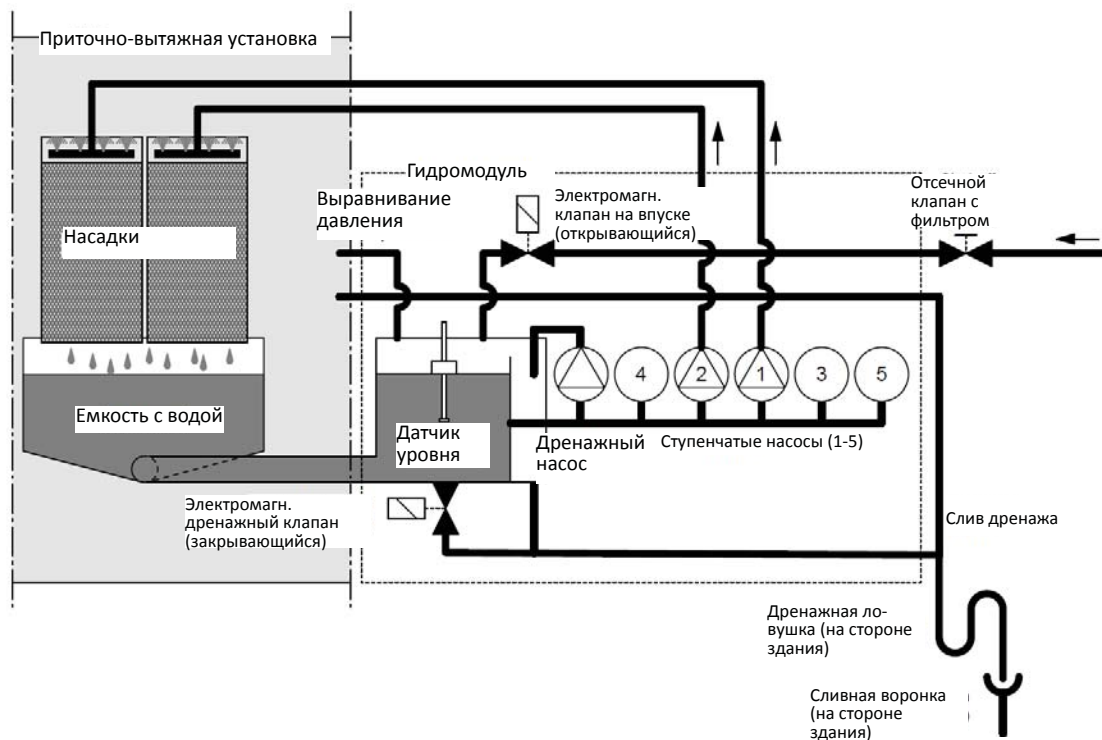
гидравлическая схема Condair ME Control (внешний монтаж гидро модуля)
